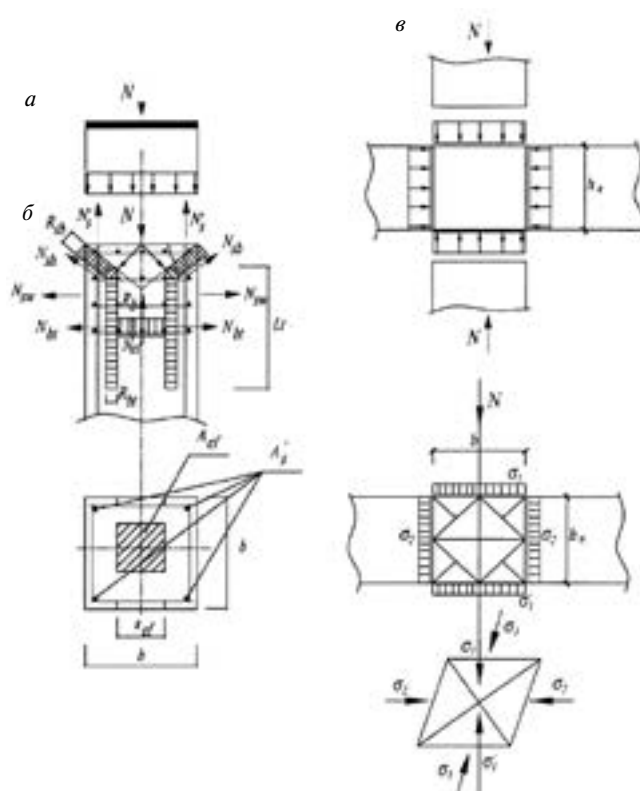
Расчетная схема стыка при передаче монтажных нагрузок через синтетическую центрирующую прокладку и усилий со случайным эксцентриситетом: а, б – при расчете оголовка нижней колонны; в – межколонной плиты
